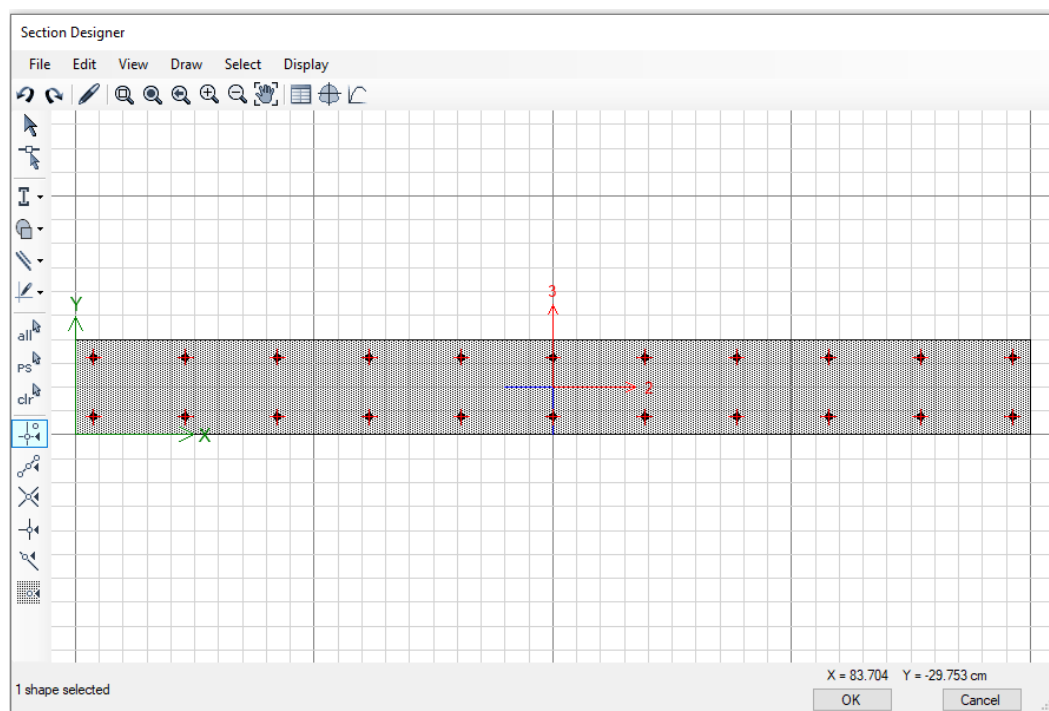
A: Sección de placa para ascensores. Fuente: Elaboración propia
